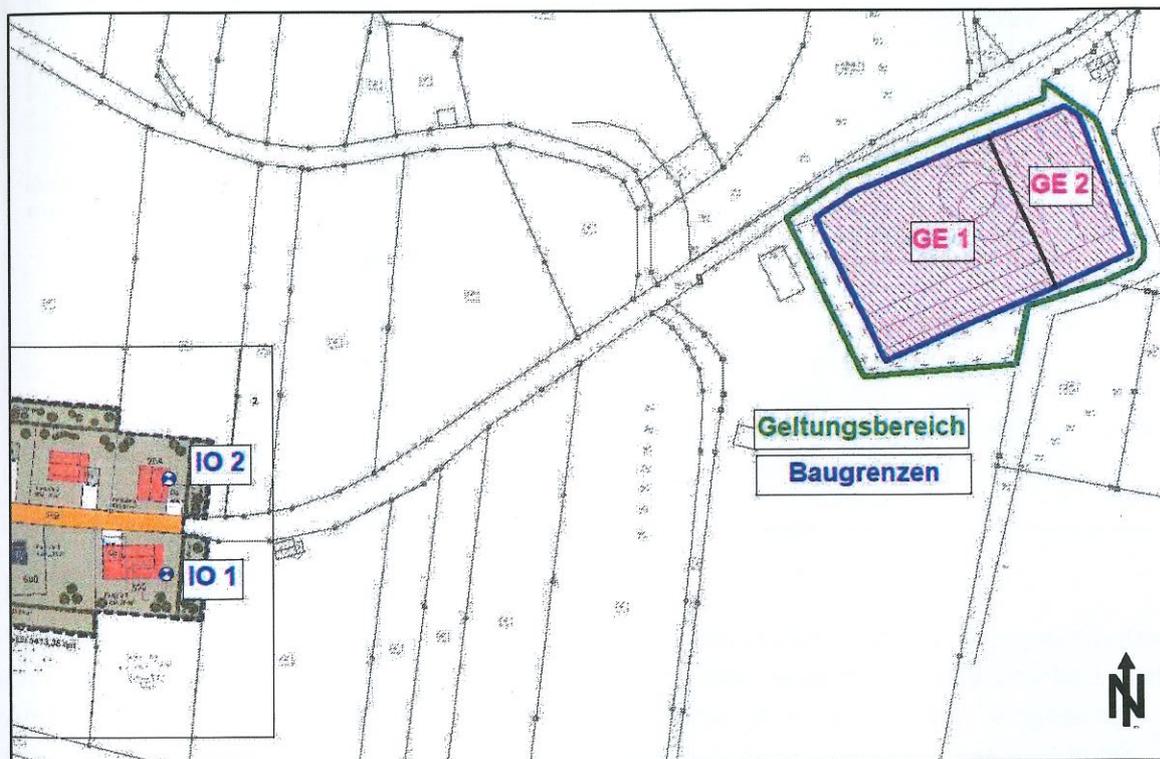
Lageplan zur geplanten 1. Änderung der Satzung (Fassung vom 12.07.2022)
